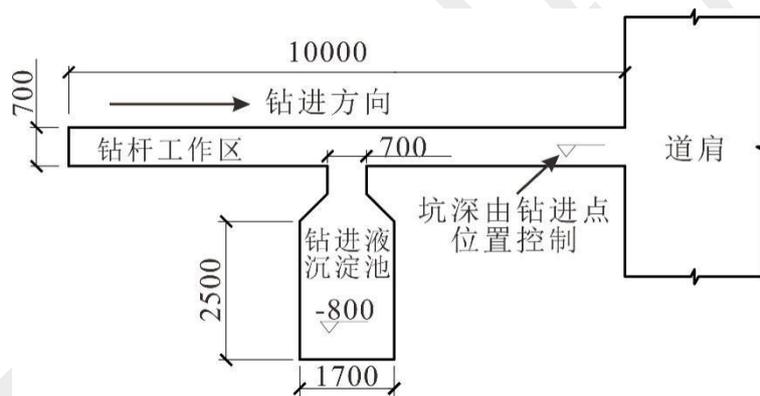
起始工作坑开挖平面示意图 (单位: mm)
